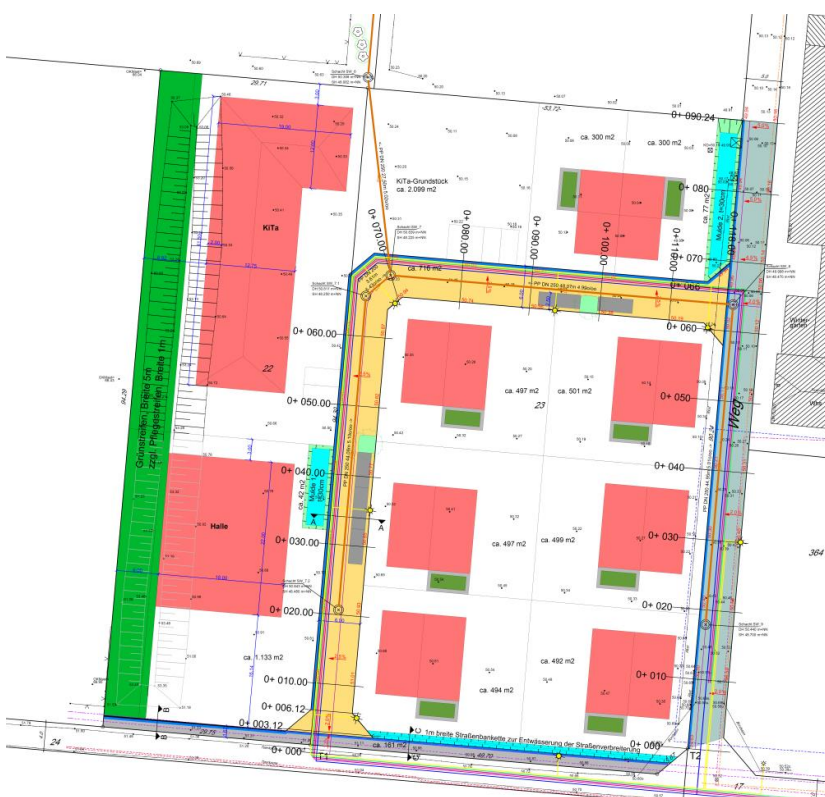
Auszug aus dem Lageplan zum Bauantrag (ATELIER STADT & HAUS GMBH, 01.08.2024)
